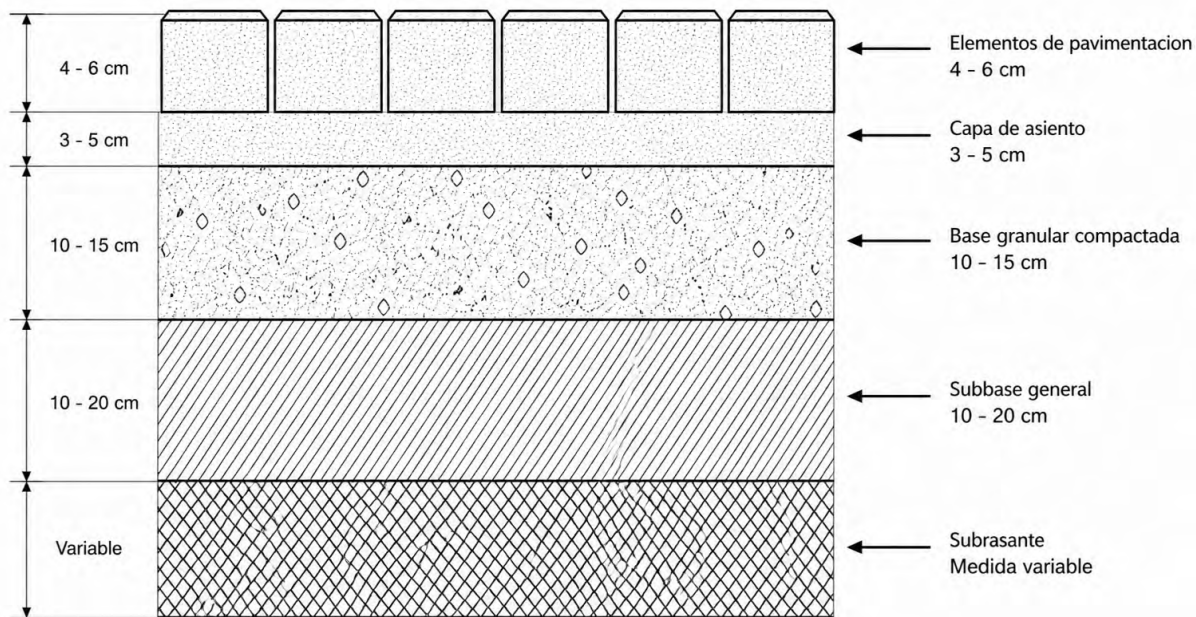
Sección constructiva de pavimento con adoquines de hormigón. Se muestran las capas estructurales (elementos de pavimentación, capa de asiento, base granular compactada, subbase granular y subrasante) con sus respectivos rangos de espesor. Nota. Imagen adaptada y editada mediante IA generativa (ChatGPT) a partir de una referencia obtenida de internet
